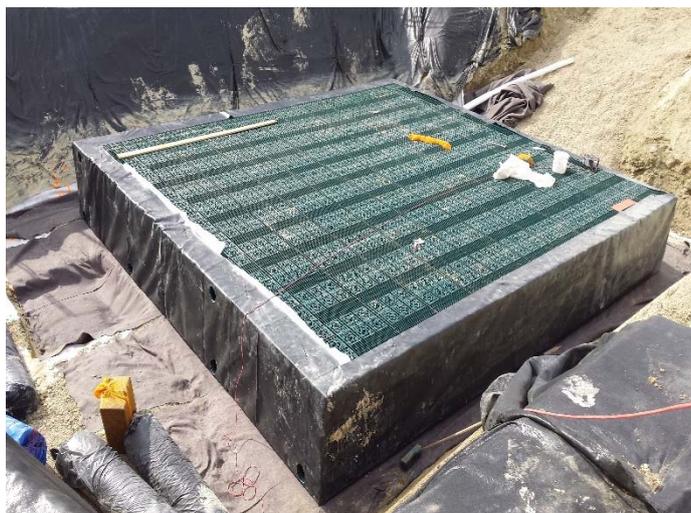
Première étape de soudure pour réaliser l'étanchéité totale
